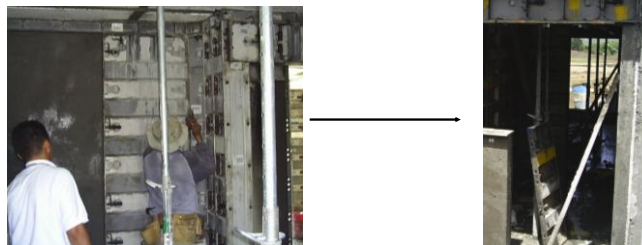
RETIRO DE LA CIMBRA EN MUROS DEL MOLDE AZUL DESPUÉS DEL PRIMER COLADO.
